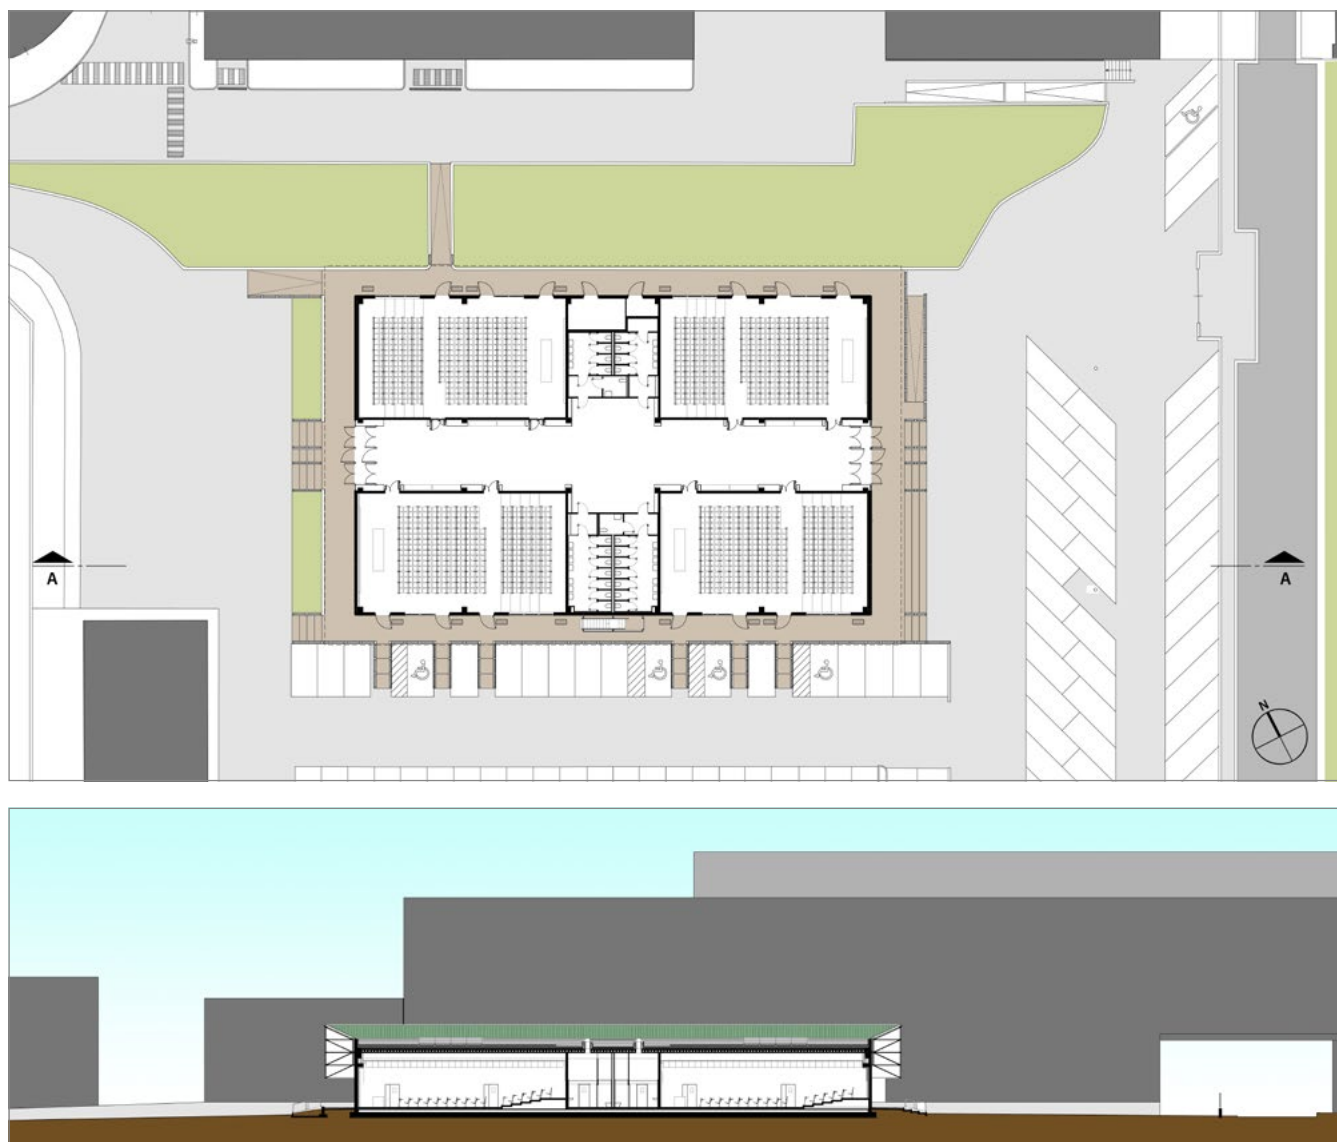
Pianta e sezione longitudinale (rielaborazione da tavole originali in scala 1:50).
